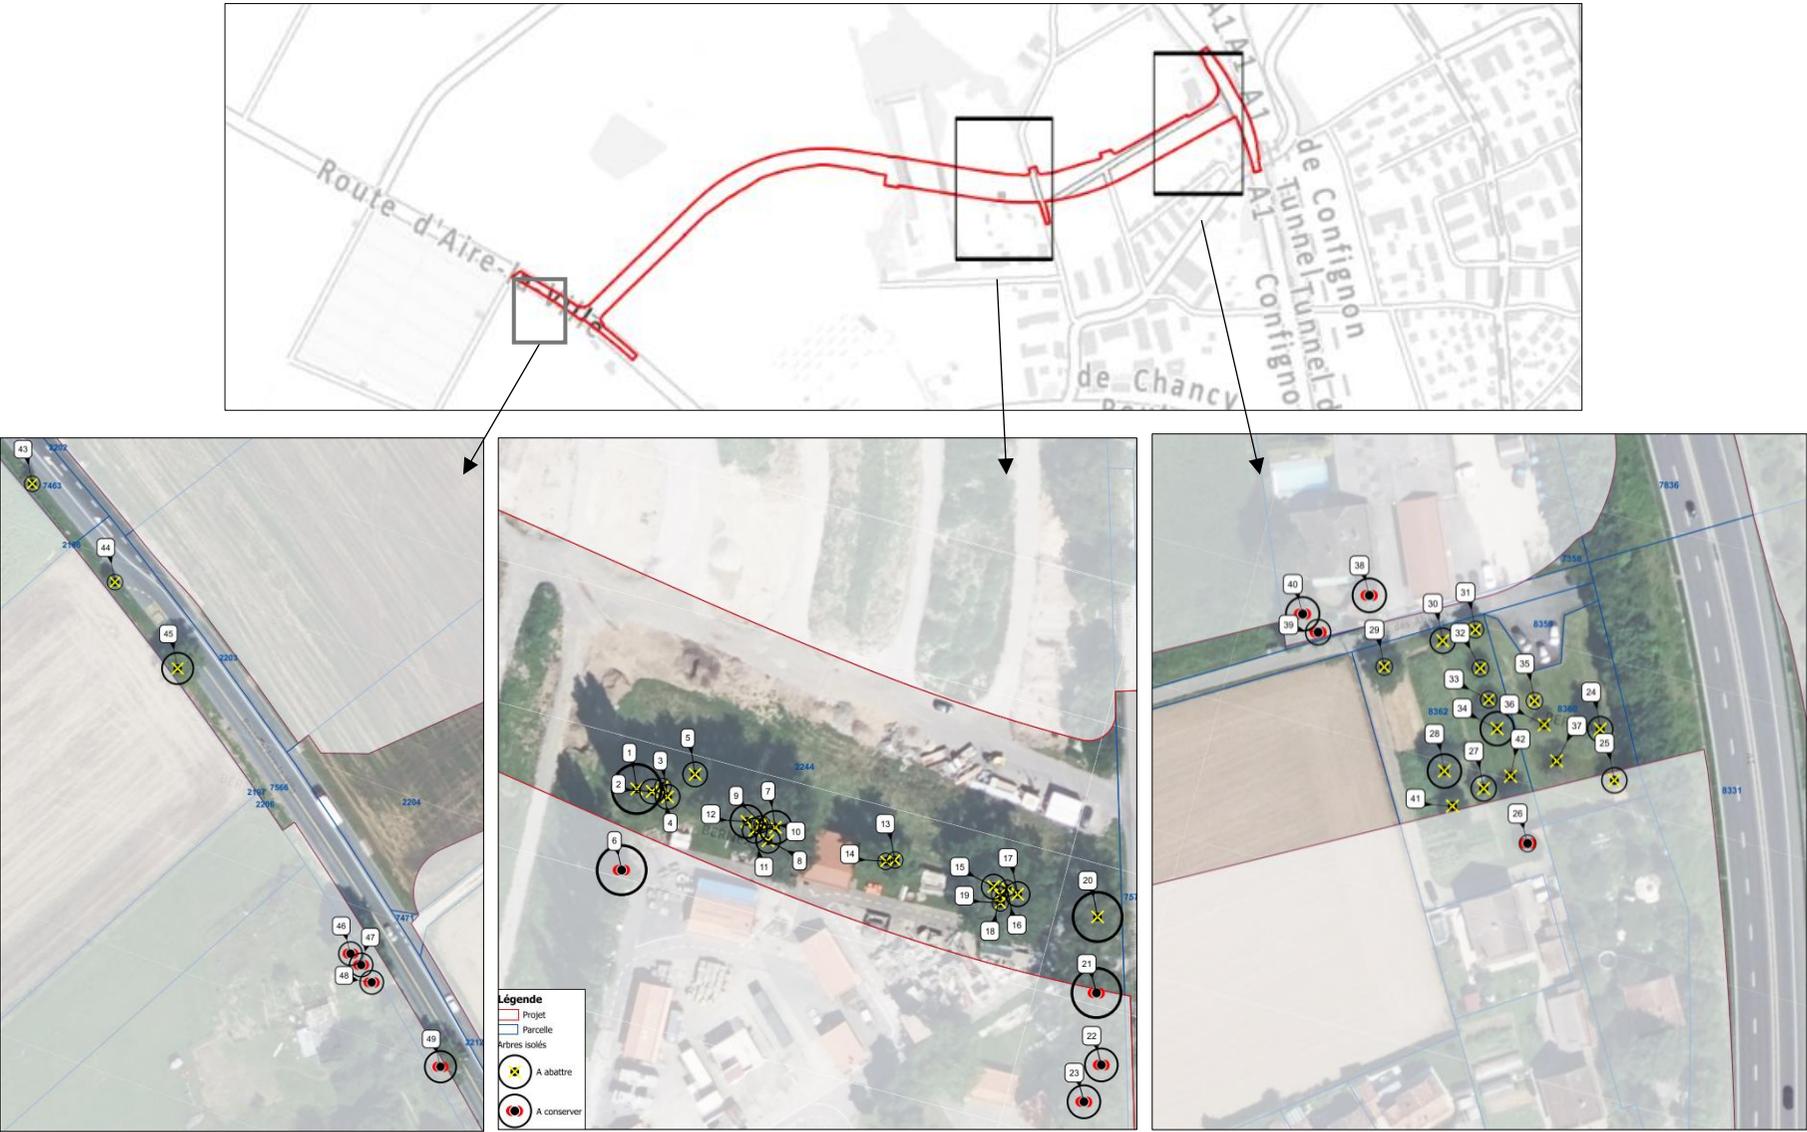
Extrait du plan d'abattage – zooms sur les trois zones d'abattage
